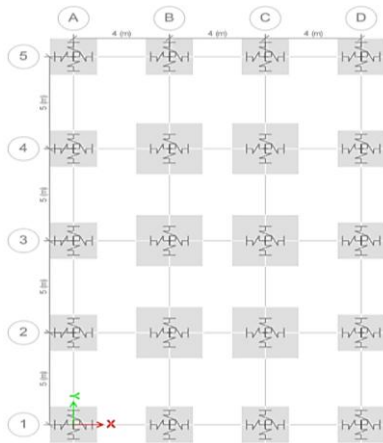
Vista de planta para modelo zapata aislada en edificio de 5 pisos
